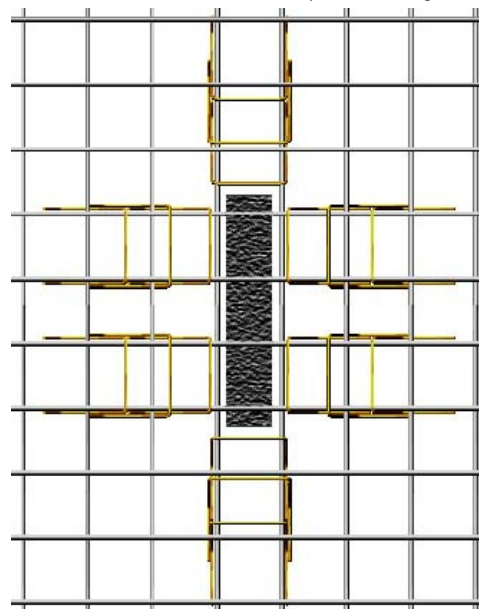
Detalhe da distribuição dos estribos nas lajes L4 e L5
